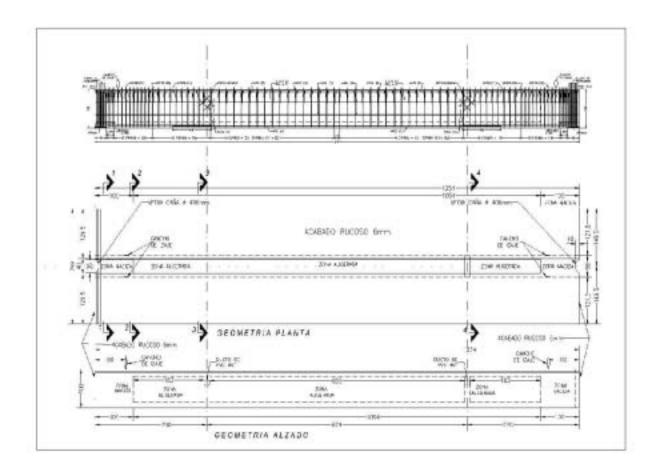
Corte y armado tipo en extremos de trabes o losas Omega de rigidez.
